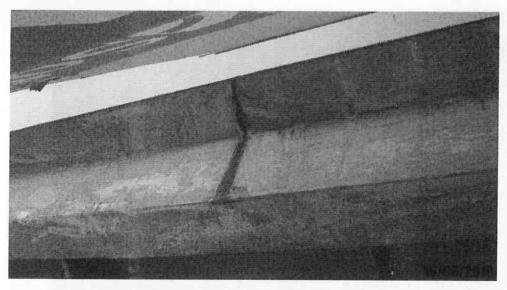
Detalhe da face inferior da viga com armadura exposta e infiltração na junta de dilatação.
